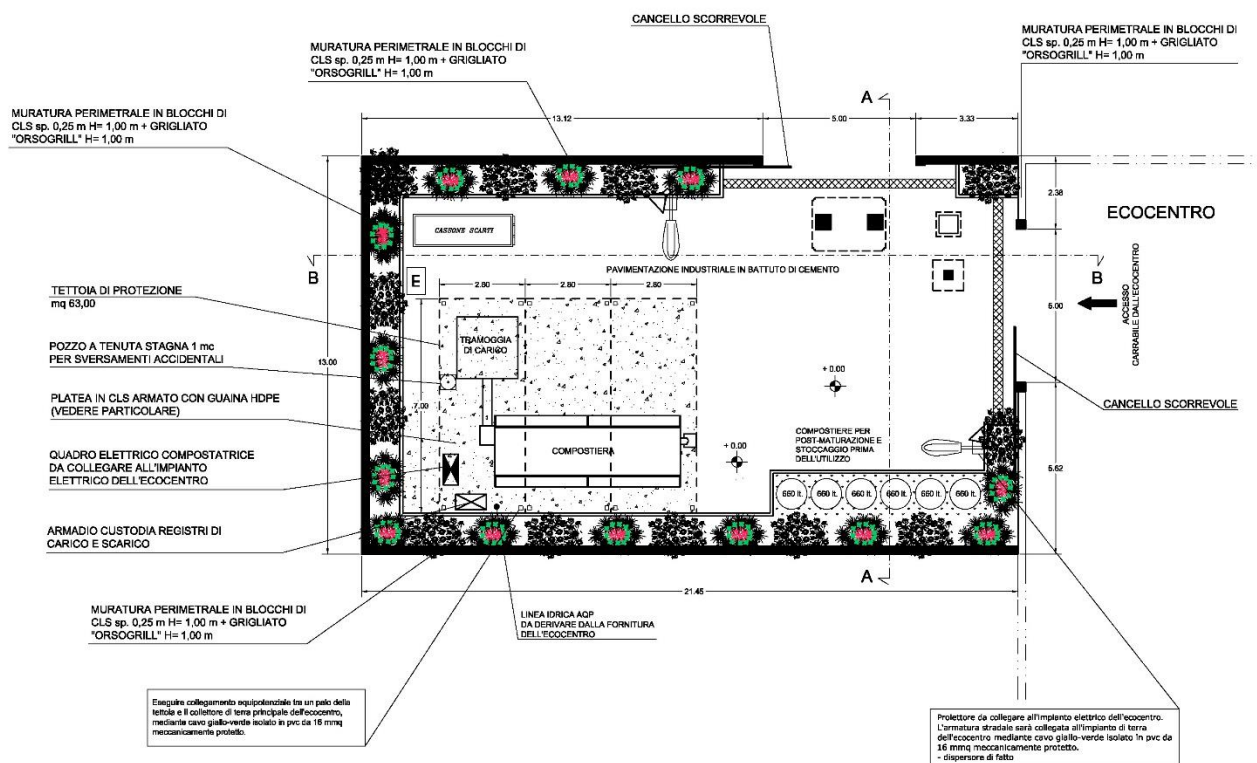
Planimetria di dettaglio centro comunale di compostaggio collettivo
